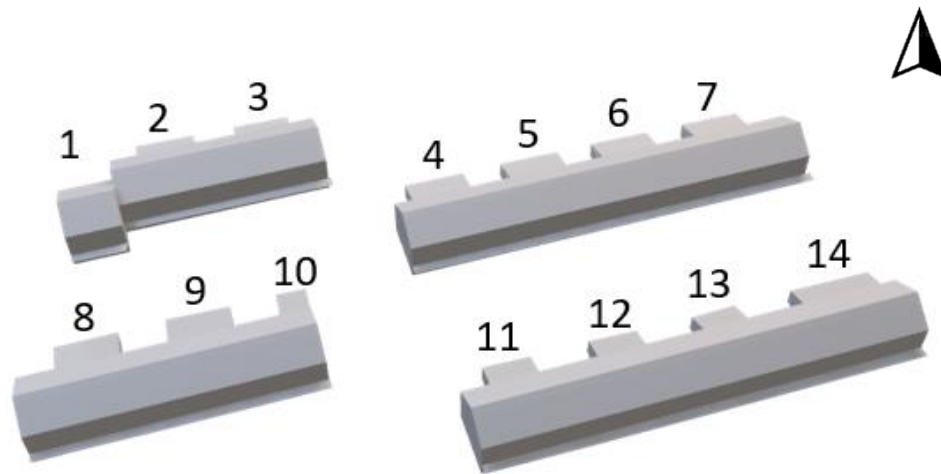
Tipologías Sant Quirze. Fuente: Elaboración propia
